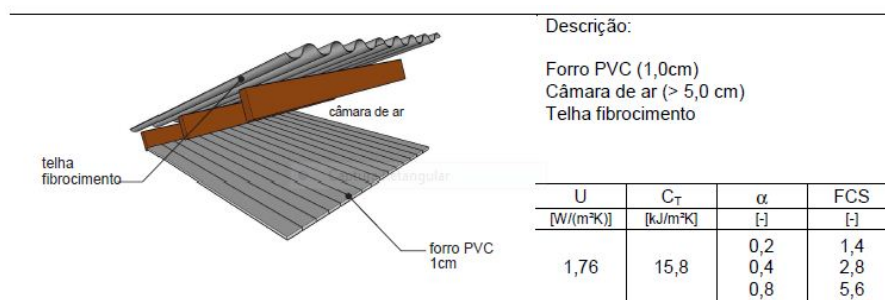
Telhado de fibrocimento com forro de PVC (LabEEE 2010)
